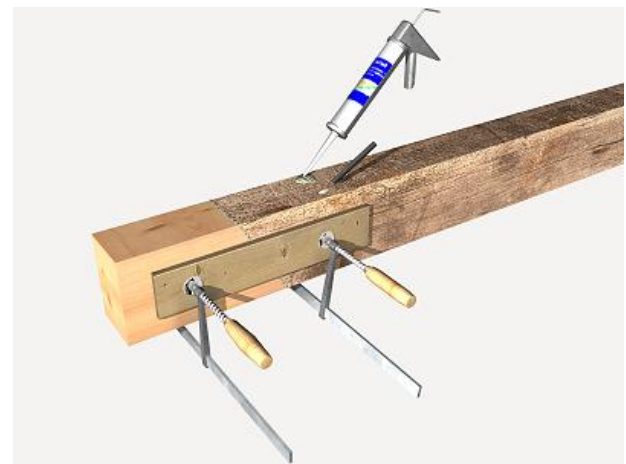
Detalle constructivo sistema Beta, Generador de precios Cype
